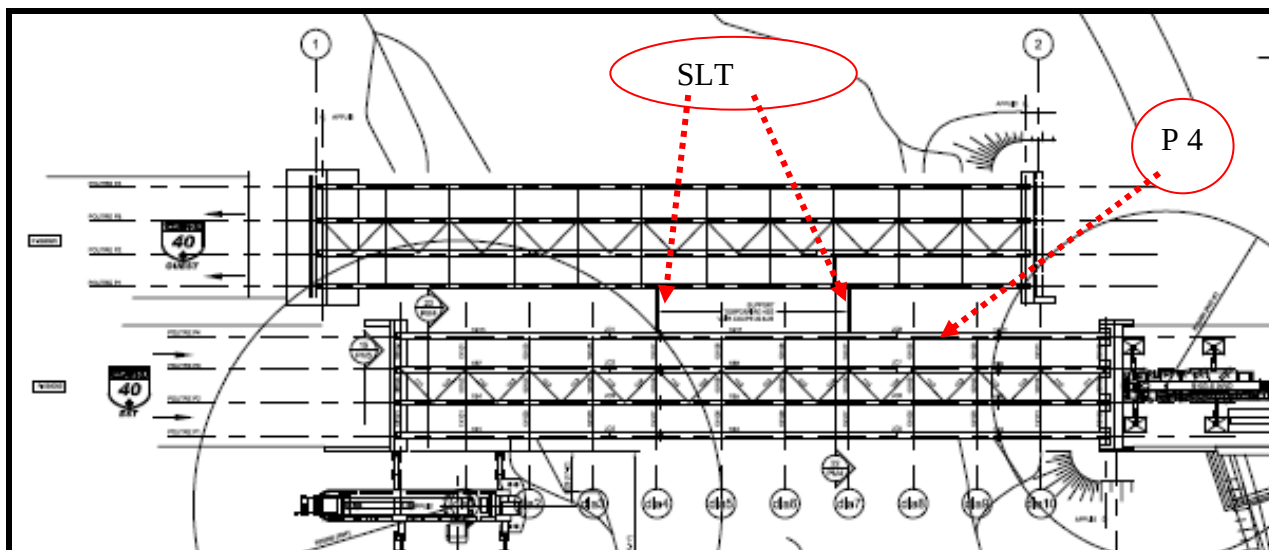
Position des supports latéraux temporaires reliant la poutre P4 au pont existant, extrait du Plan PM2, émis pour approbation – 12 avril 2016.
